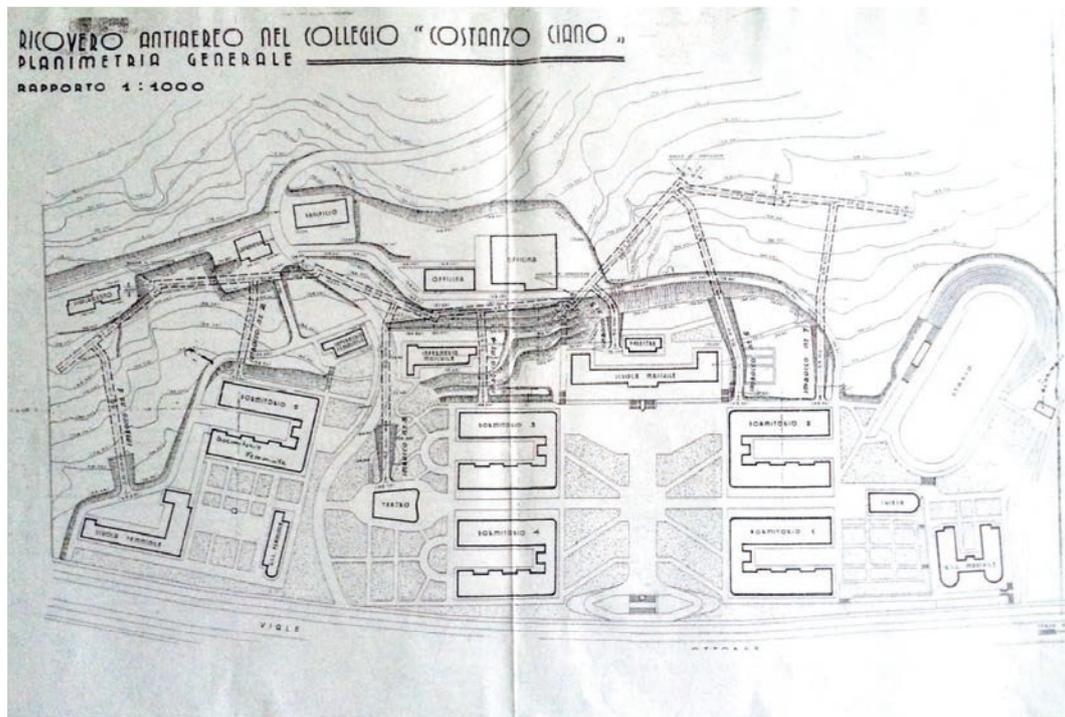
| Il Collegio Ciano: planimetria di progetto (1938).
